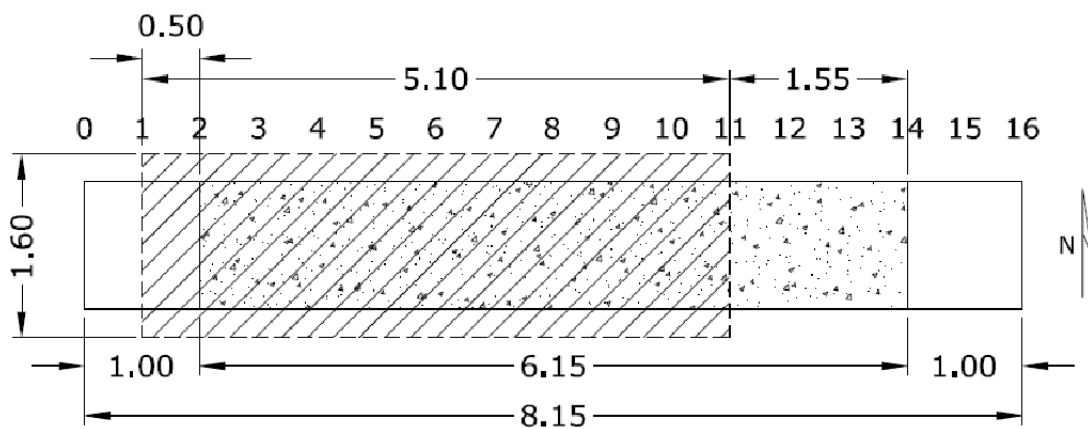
Zona de medición del perfil tridimensional de las pistas de ensayo
